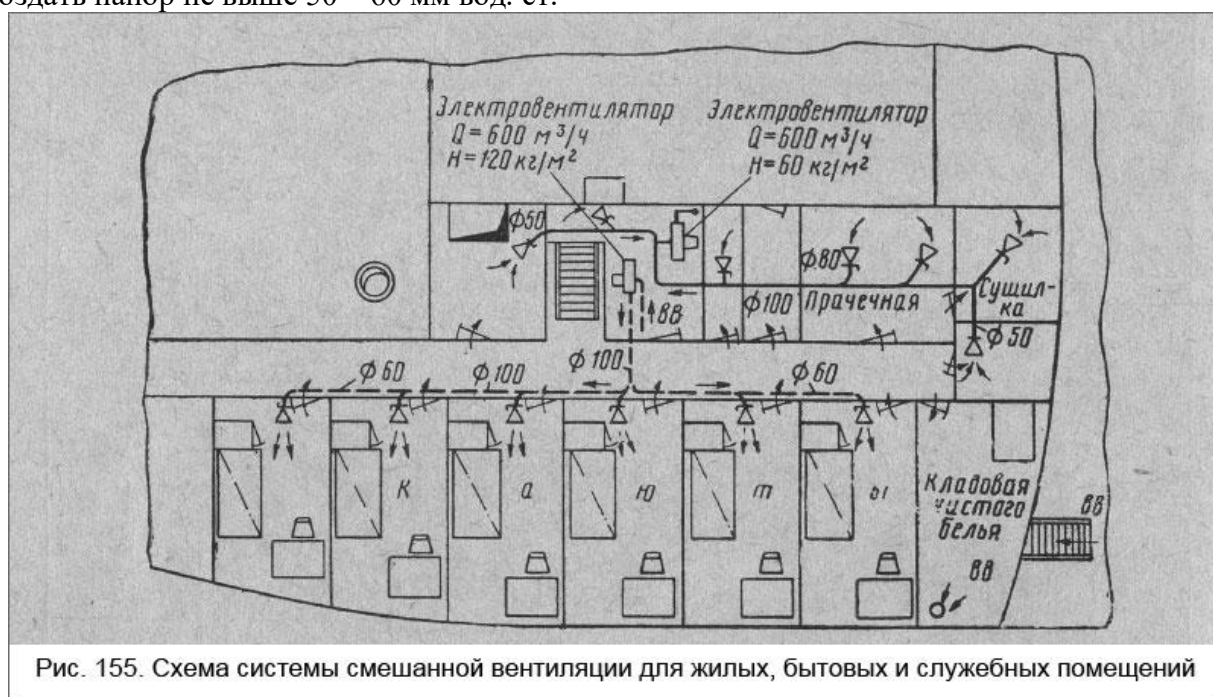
Схема системы смешанной вентиляции для жилых, бытовых и служебных помещений
